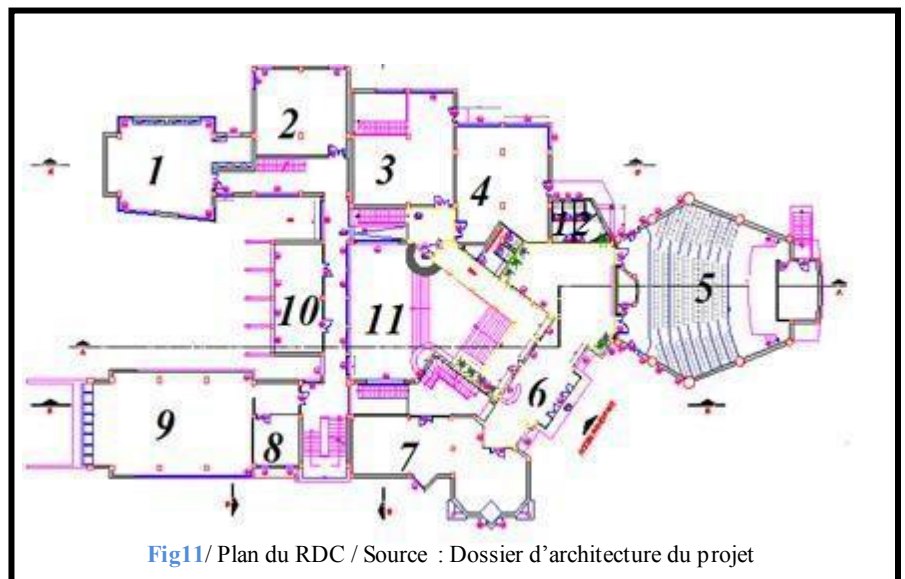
/ Plan du RDC / Source : Dossier d'architecture du projet
